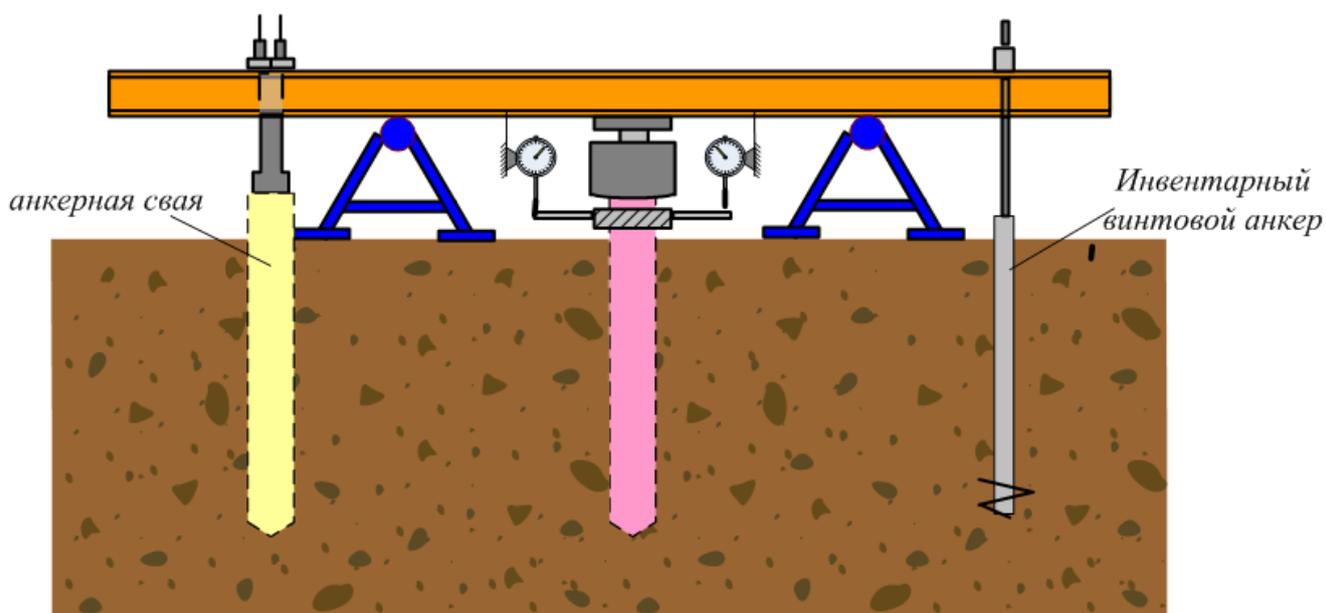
Схема испытания натурной сваей с применением а)- анкерной сваи или б)- винтового анкера: 1- испытываемая свая; 2- домкрат; 3- датчики деформаций; 4- упорная рама.
